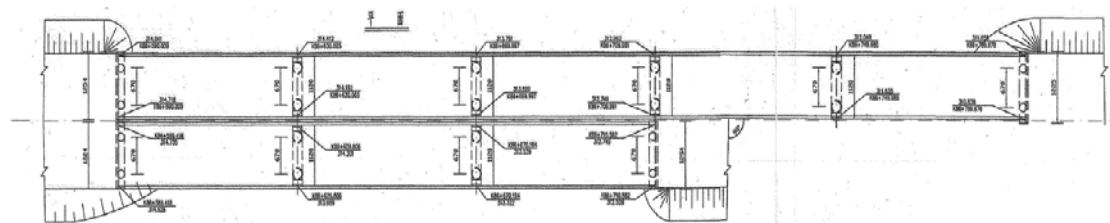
杨柳坪大桥平面图（单位：cm）
